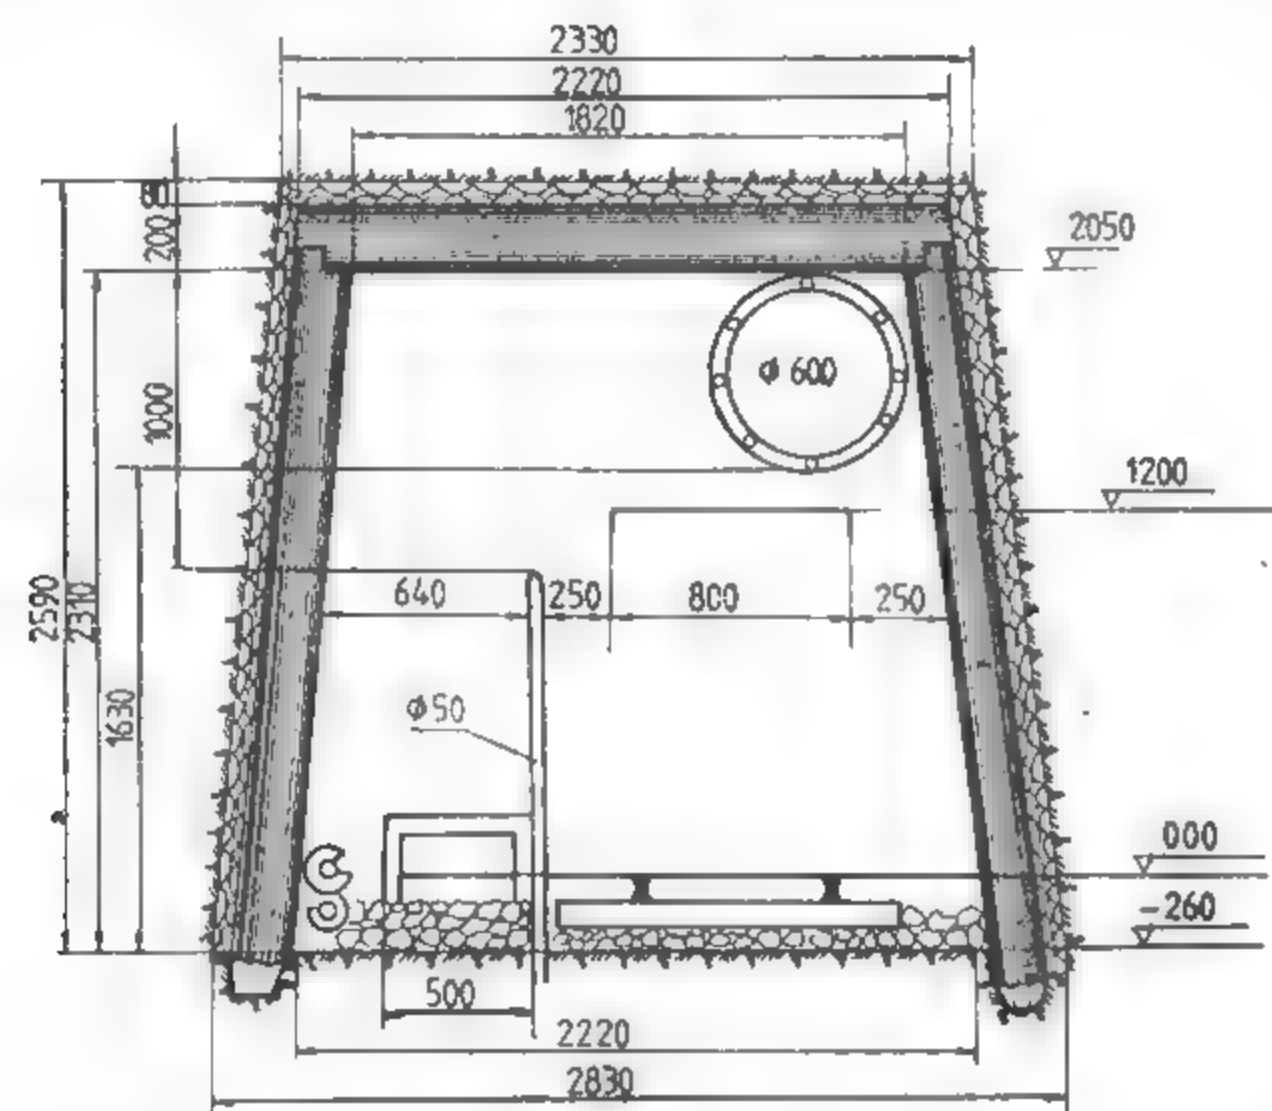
Plan înclinat PL1L — 6,70 m<sup>2</sup>, cu profil trapezoidal, susținut în lemn.
